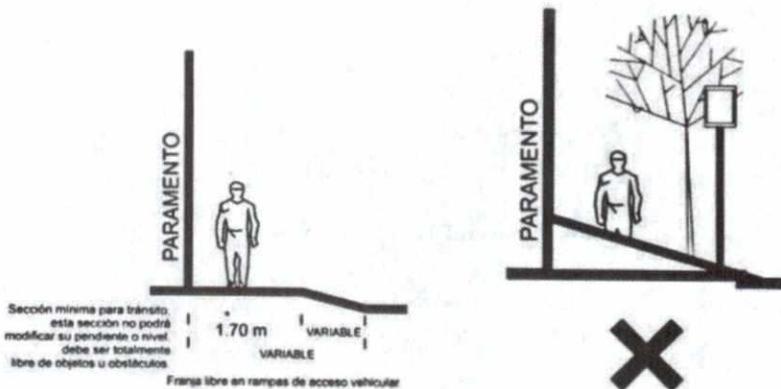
Esquema de rampas vehiculares sobre banquetas
